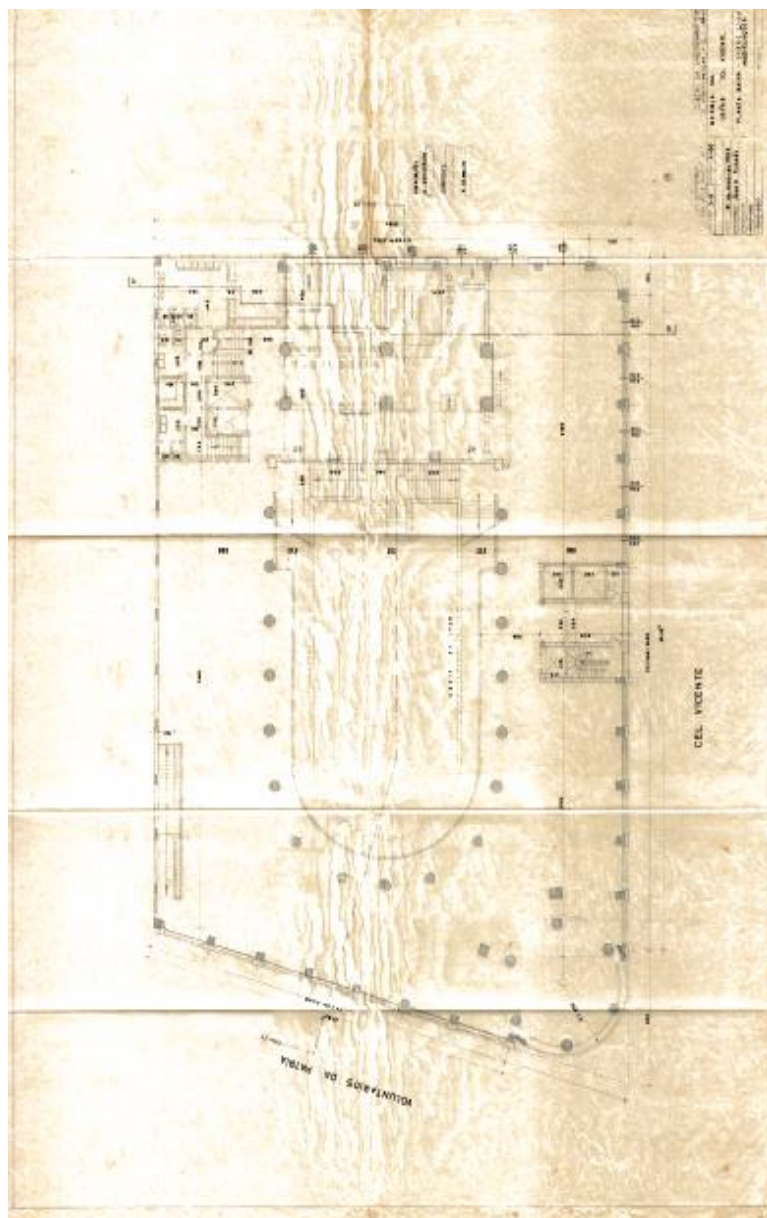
Planta Baixa Arquitetônico da Sobrelôja original com outra opção de layout de lancheria ao fundo (1963).
